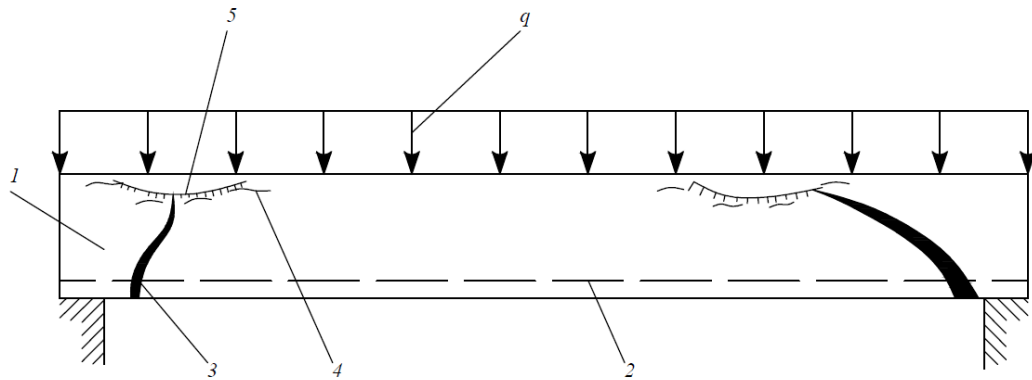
Трещины и разрушение бетона в наклонном сечении:
